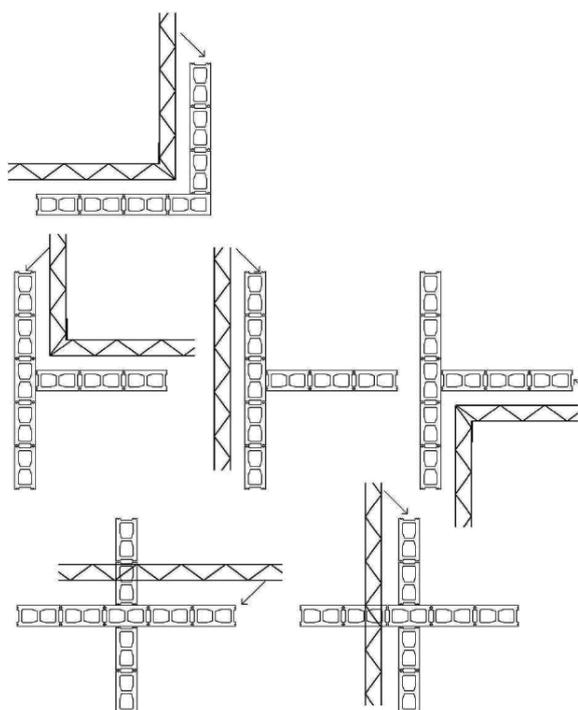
Esquina, encuentro y cruce de muros de fábrica armada con cerchas de tendel prefabricadas.
